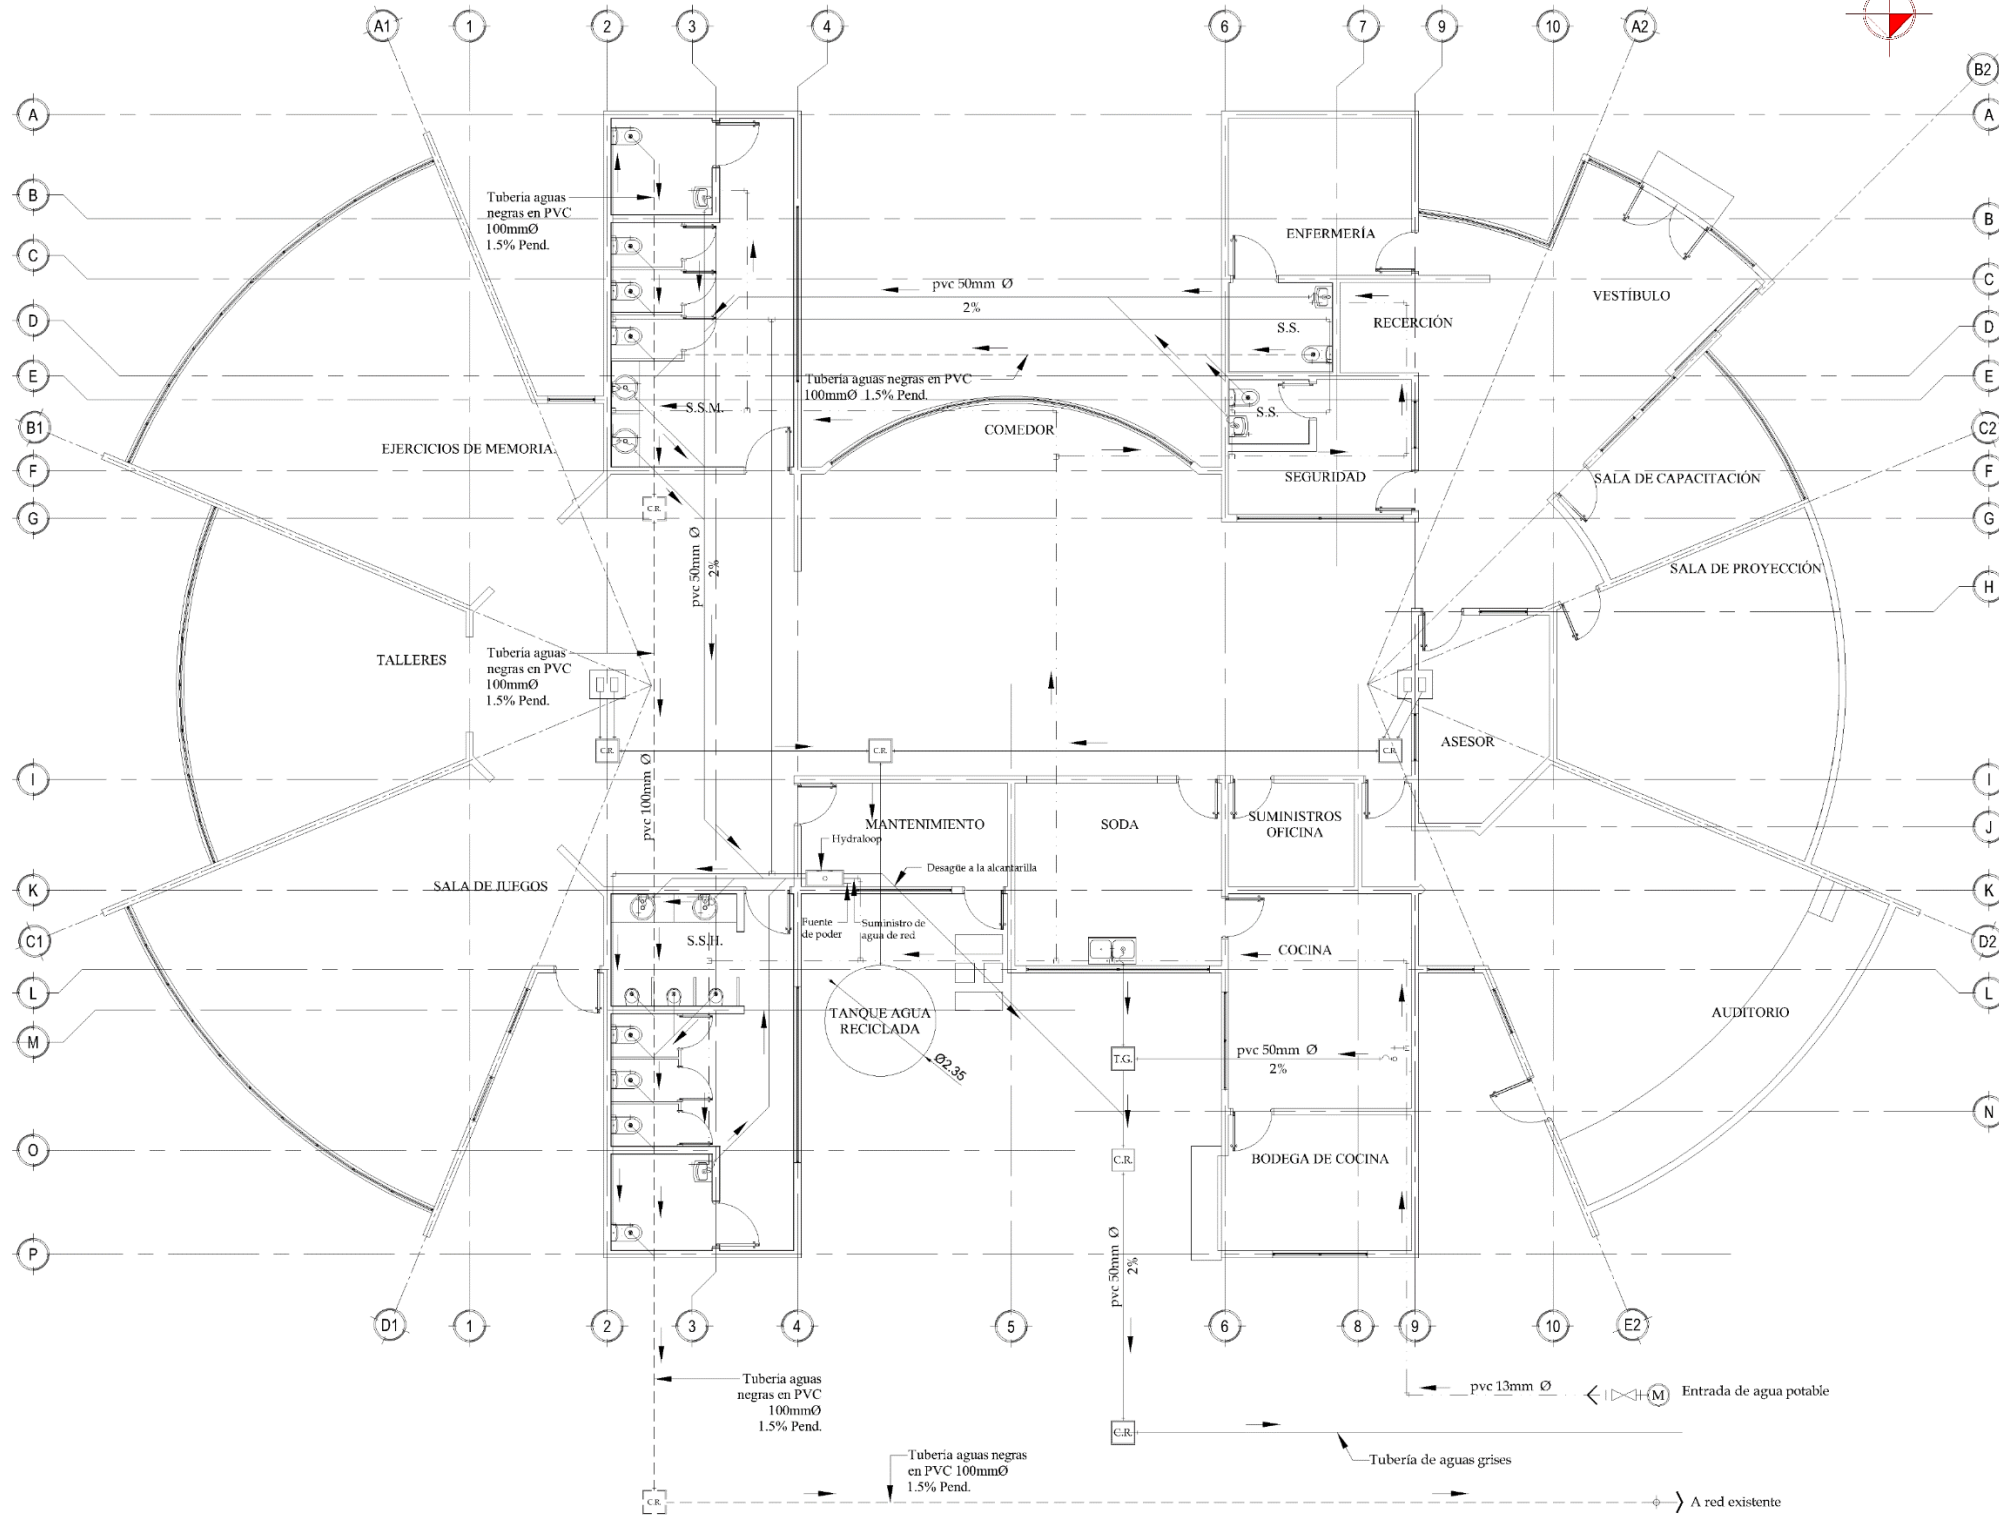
Planta mecánica. Fuente: elaboración propia.
